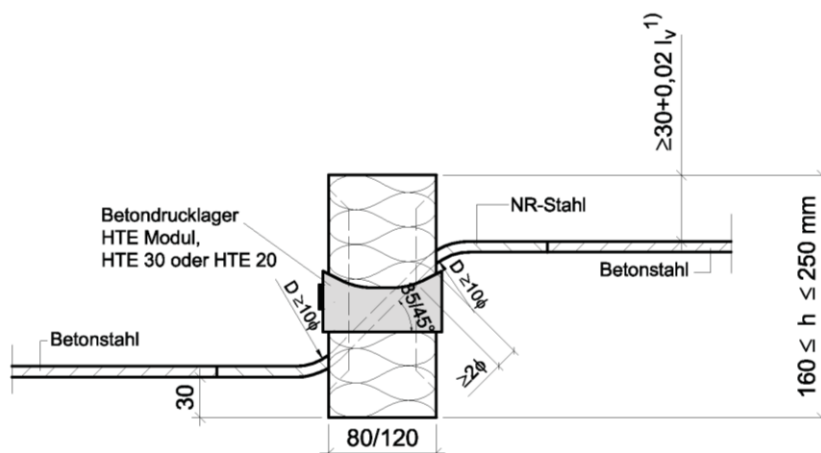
Schöck Isokorb Typ RQ-240 mit Betondrucklager
